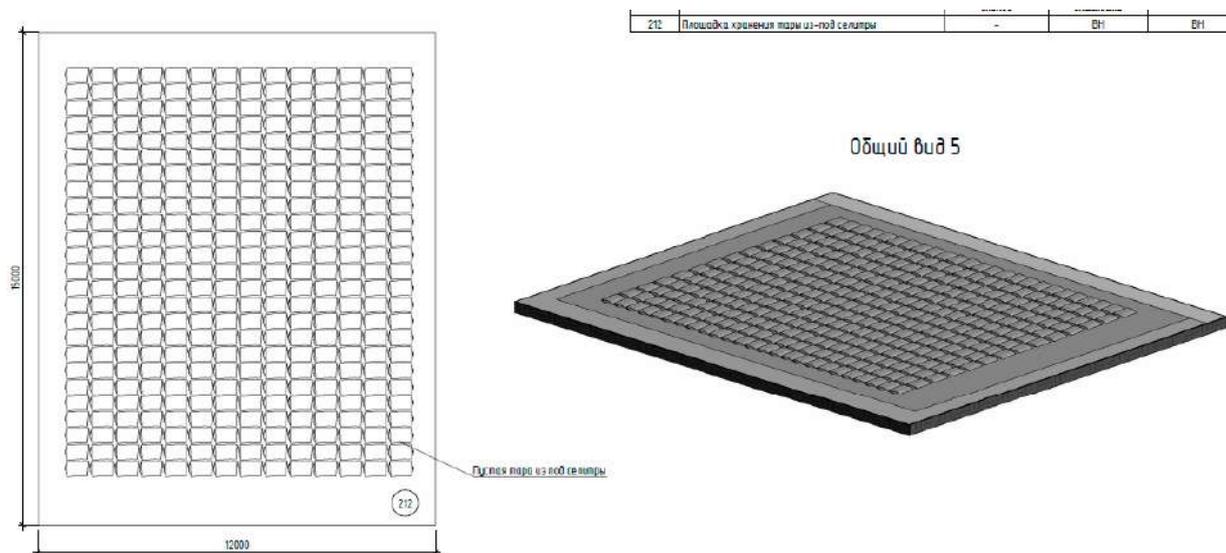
9. План-схема площадки хранения пустой тары из-под селитры
